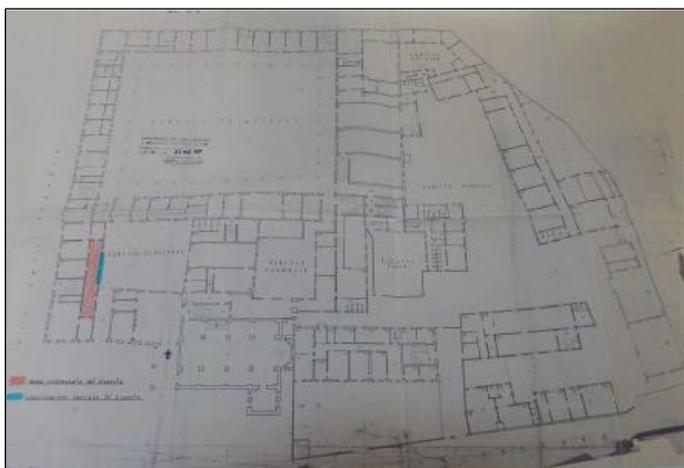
Planimetria con indicazione della zona di intervento sul lato del chiostro piccolo (1985-87)
